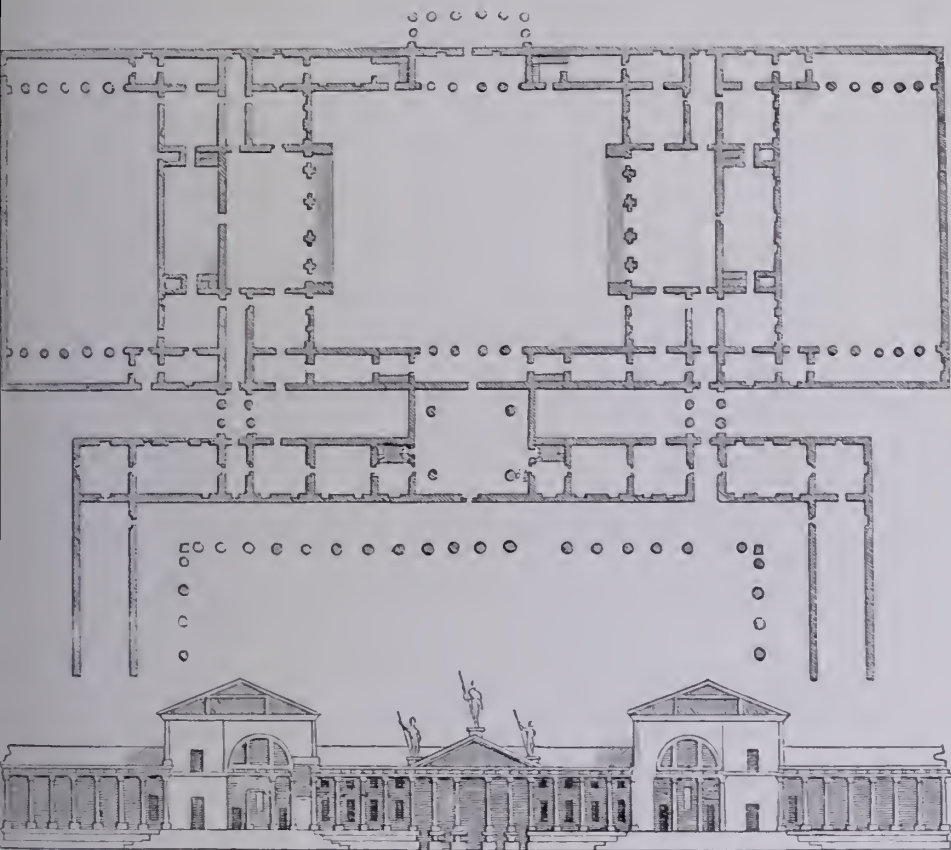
Quinto nel Vicentino, Villa Thiene. Palladio: Pianta e prospetto.
